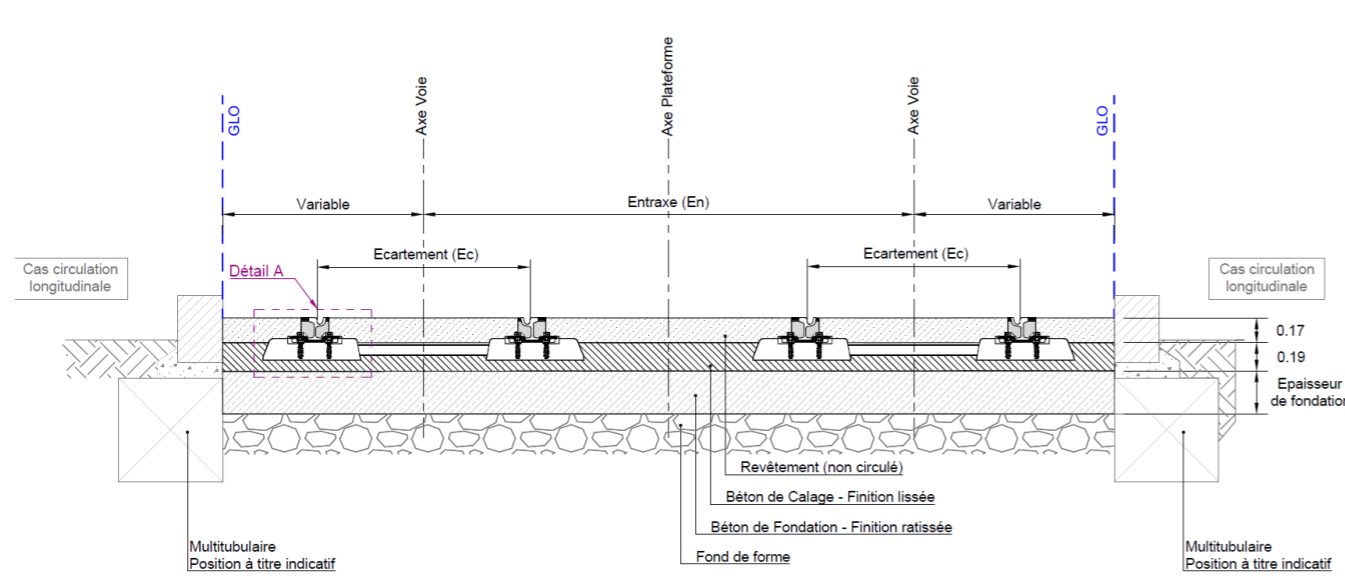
coupe type d'une plateforme - Voie béton traverses – Revêtement minéral circulé carrefour
